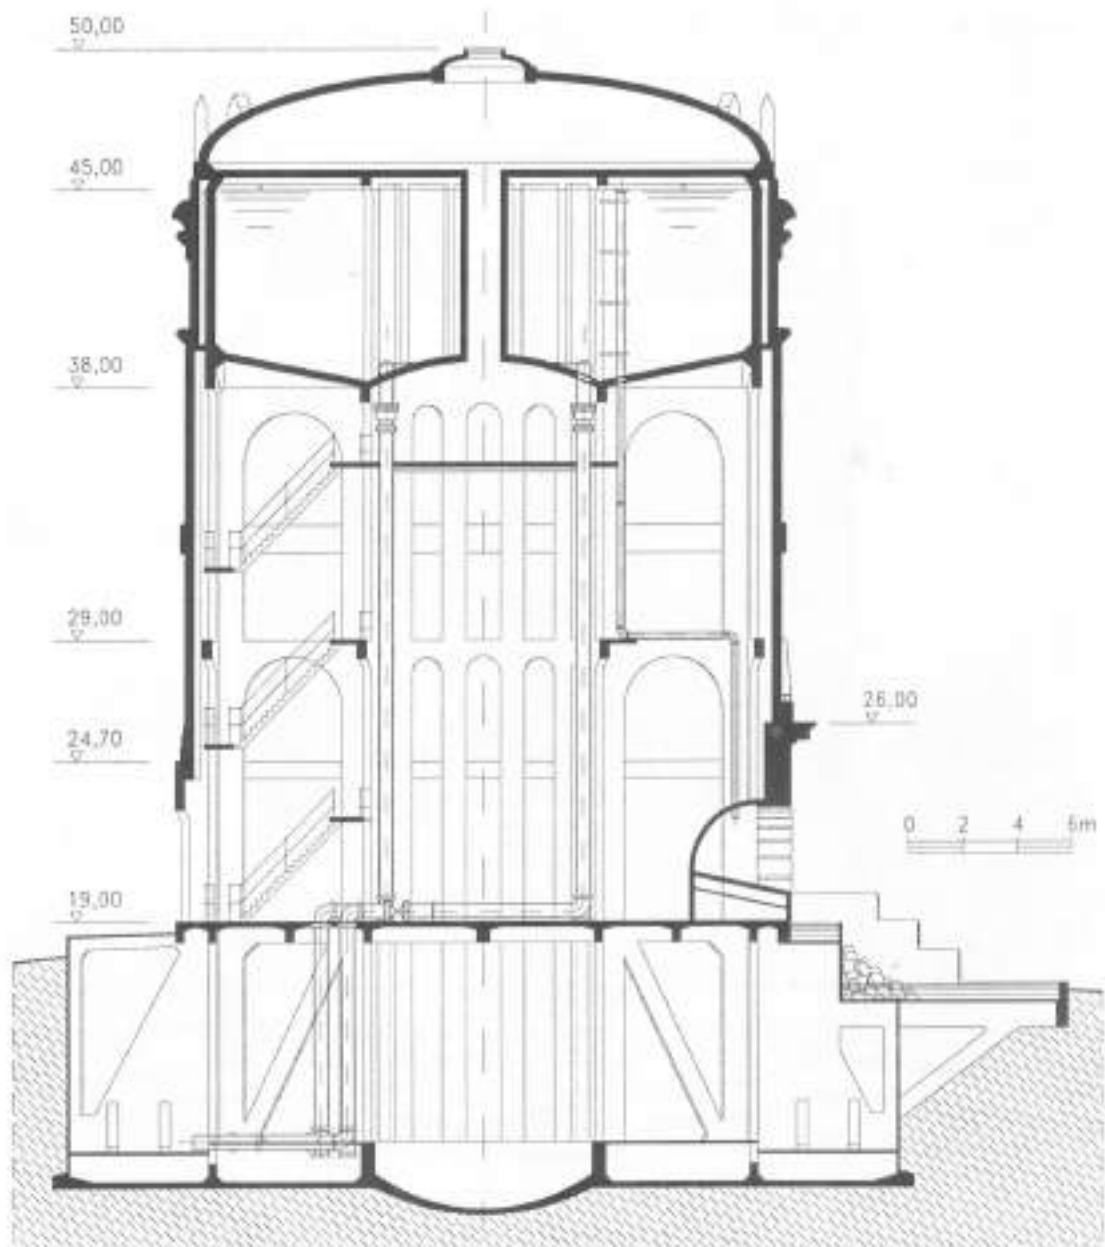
Serbatoio La Rotonda dell'acquedotto di Padova,sezione verticale.
